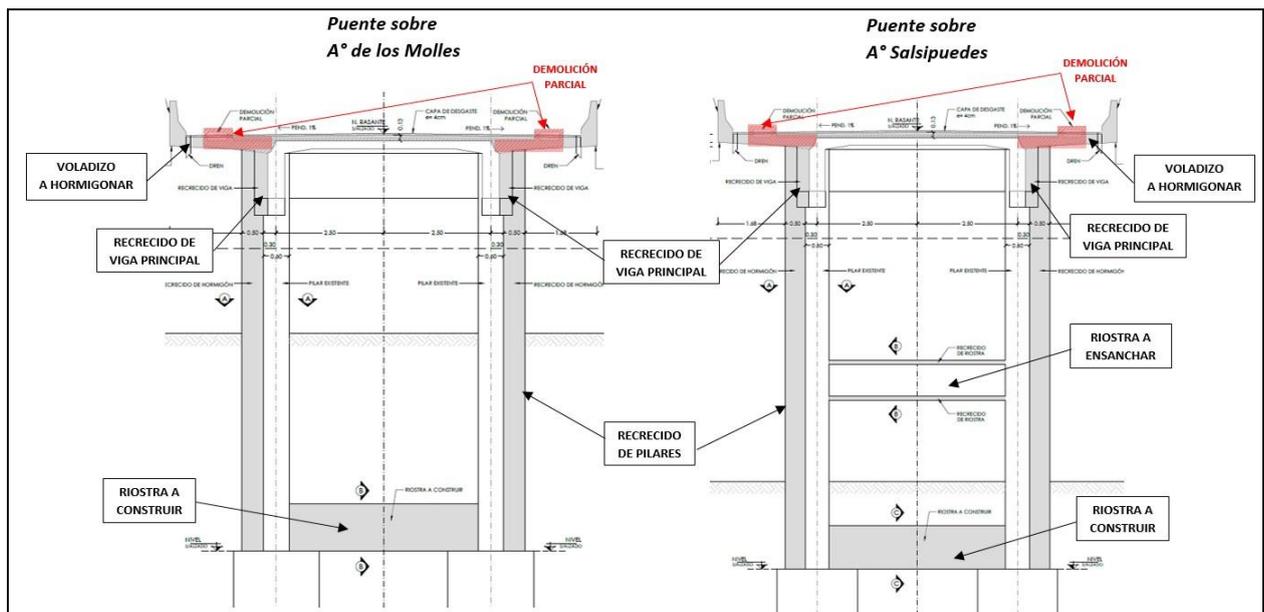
Secciones transversales tipo en pilas – Puentes tipo viga continua.
